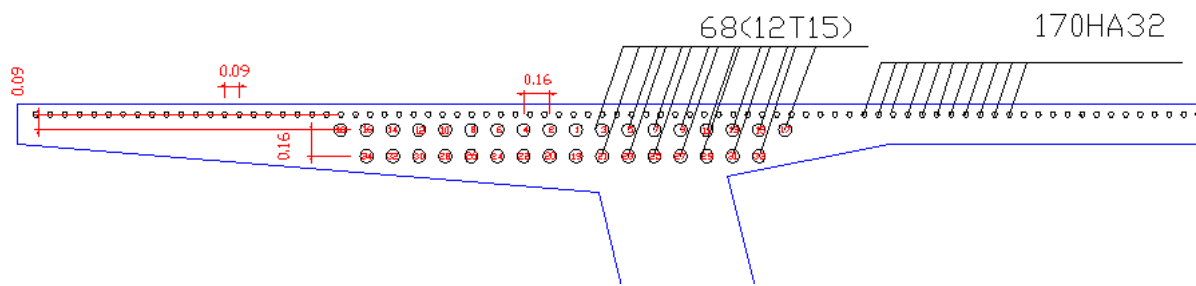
Disposition des armatures dans le voussoir sur pile.
